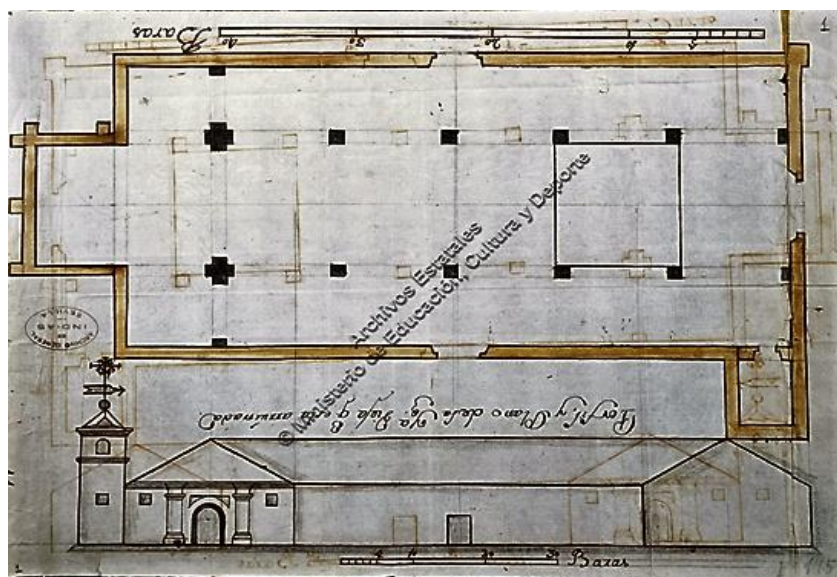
Perfil y plano de la iglesia vieja de Santa Marta arruinada, 1767.
